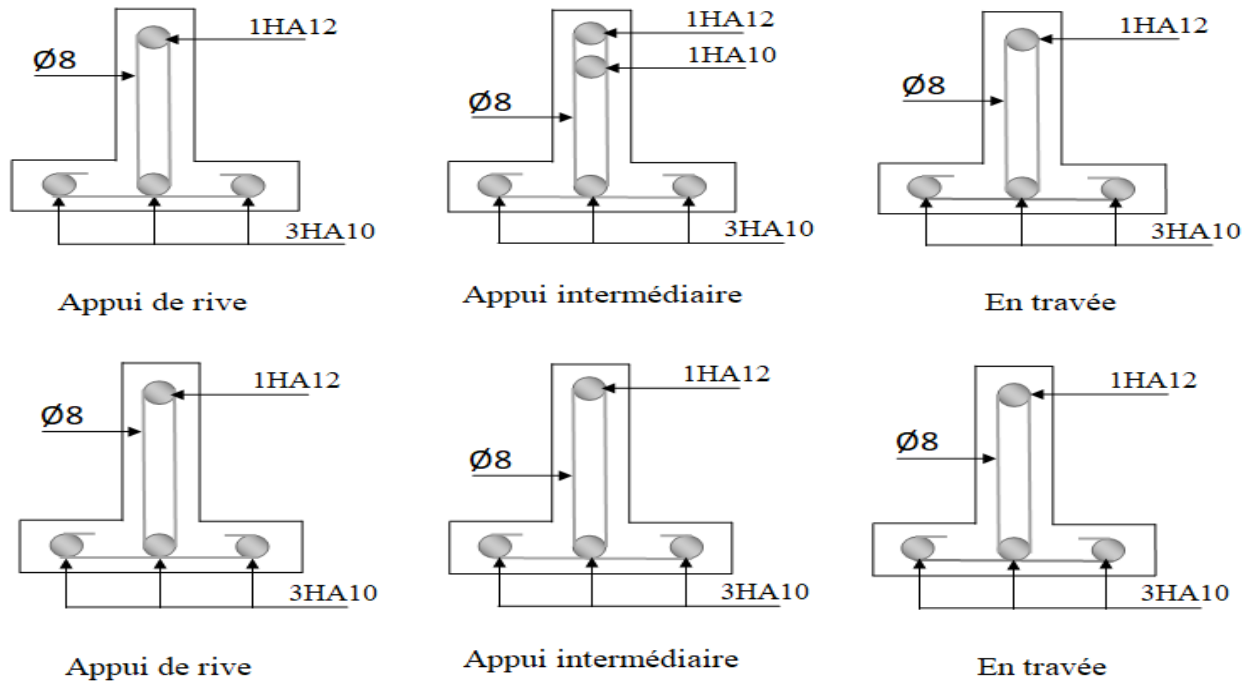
Schéma de Ferrailage des poutrelles plancher étage
